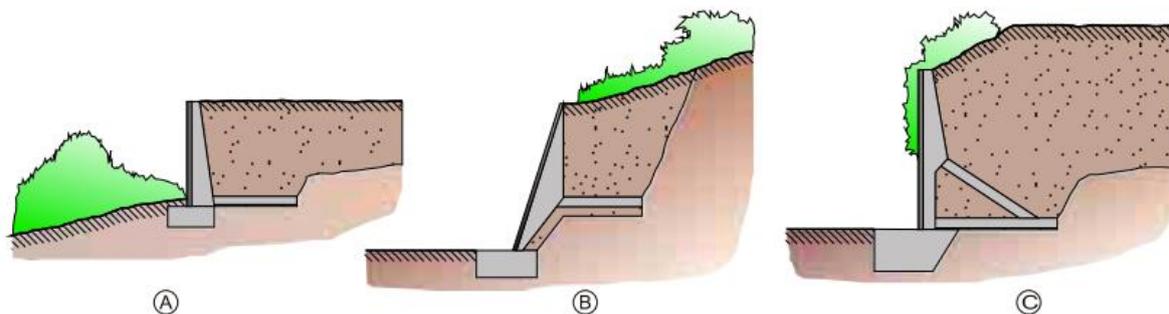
Muri in prefabbricati in c.a. A) muro incastrato alla fondazione; B) muro inclinato con base intermedia; C) muro con tirante ancorato alla base del terrapieno.
